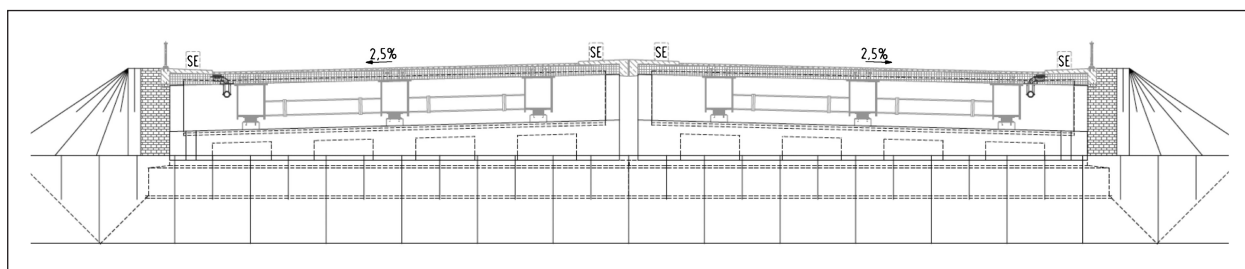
Stahlbetonhohlquerschnitt, hochgesetzte Widerlager auf Bodenaustausch
